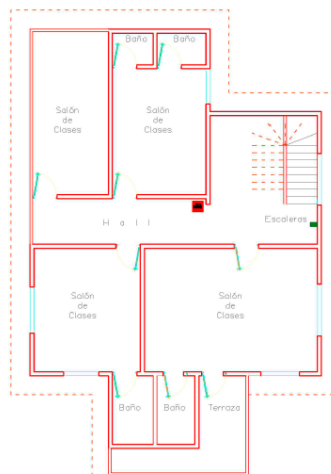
Planta Arquitectónica 2do Piso Actual Jardín Infantil. CAJACOPI.
